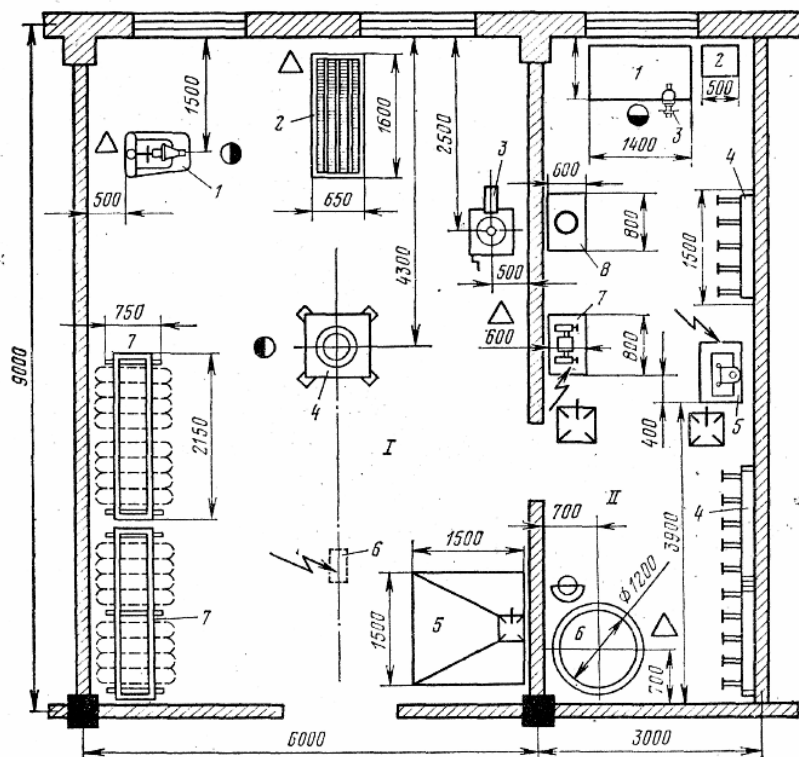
Шиномонтажне та вулканізаційне відділення ПАТ: I – шиномонтажна ділянка: 1 - пневматичний борторозширювач; 2 - кліть для накачування шин; 3 - стенд для правки дисків коліс; 4 - стенд для демонтажу і монтажу шин; 5 - камера для фарбування дисків коліс; 6 - електротельфер; 7 - одноярусний стелаж покришок; II - ділянка ремонту камер: 1 - верстак; 2 - скриня для відходів; 3 - слюсарні лещата; 4 - настінні вішалки для камер; 5 - електровулканізаційний апарат для ремонту камер; 6 - ванна для перевірки камер; 7 - шеровальний верстат; 8 - ручна клеємішалка
